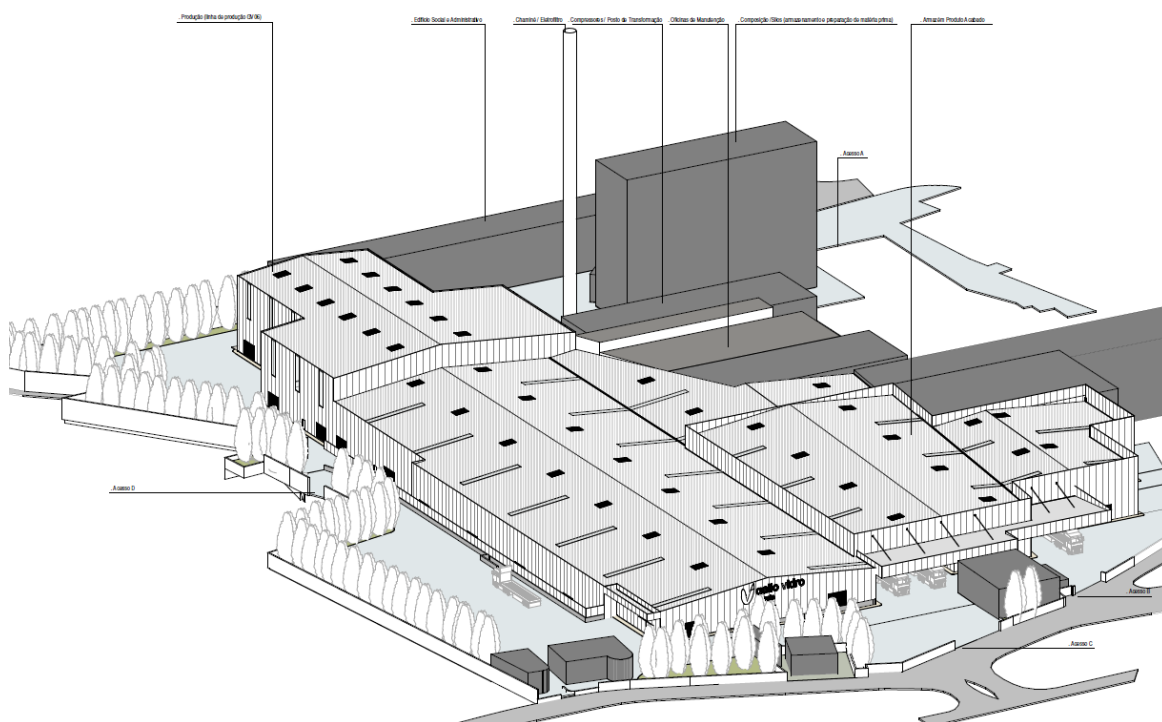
Planta 3D de implantação das instalações da GalloVidro
